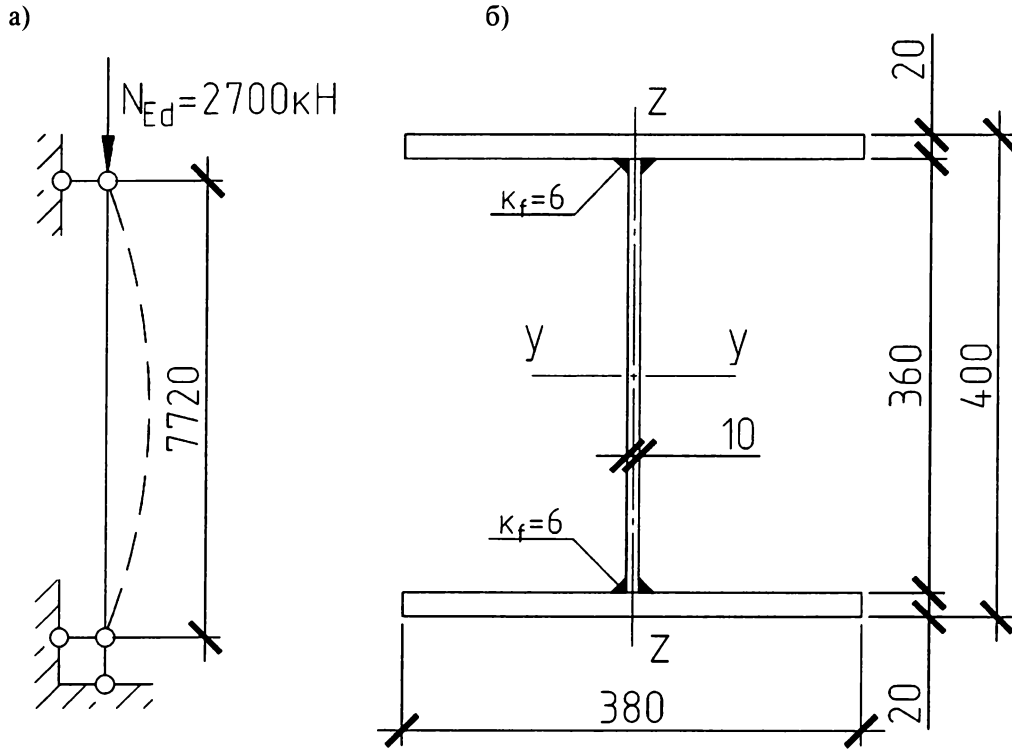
Расчетная схема (а) и сечение сварной колонны (б)
